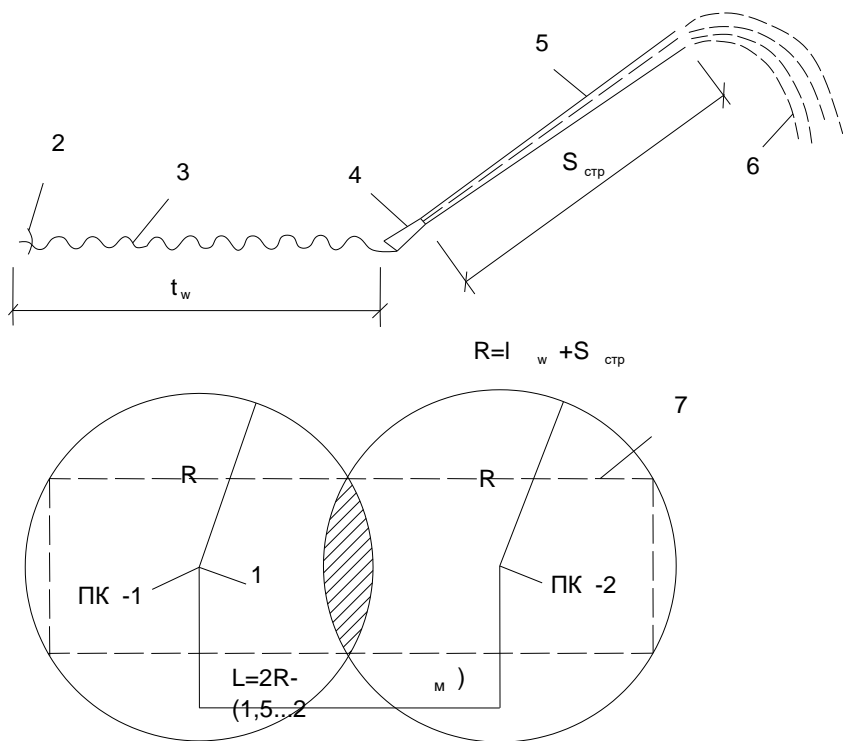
Схема действия пожарного крана, условие расстановки кранов в плане:
